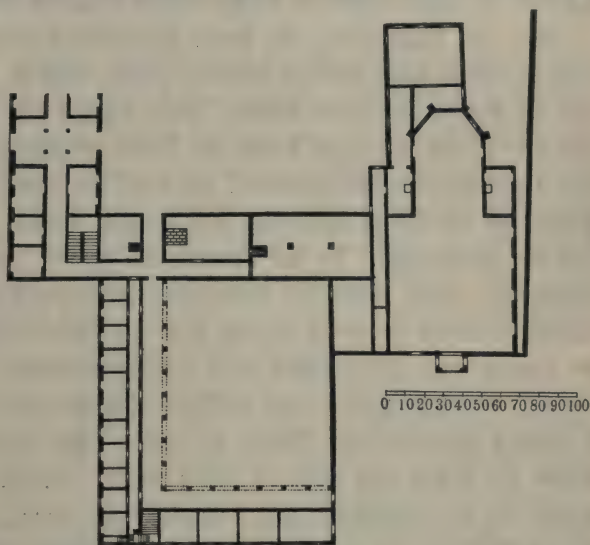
Landsberg. Kolleg mit Kirche. Grundriß.
